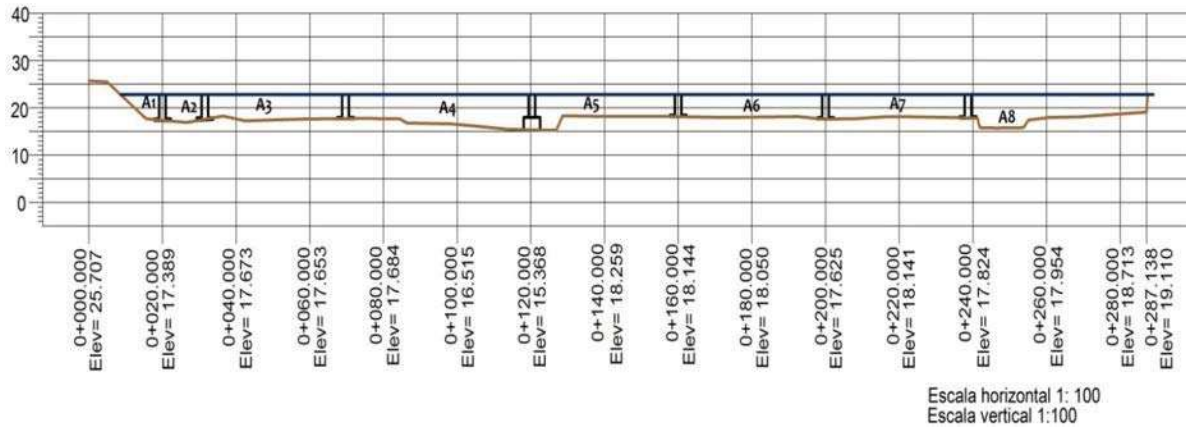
Perfil del puente Huahua, se muestran las pilas y la base del puente.
